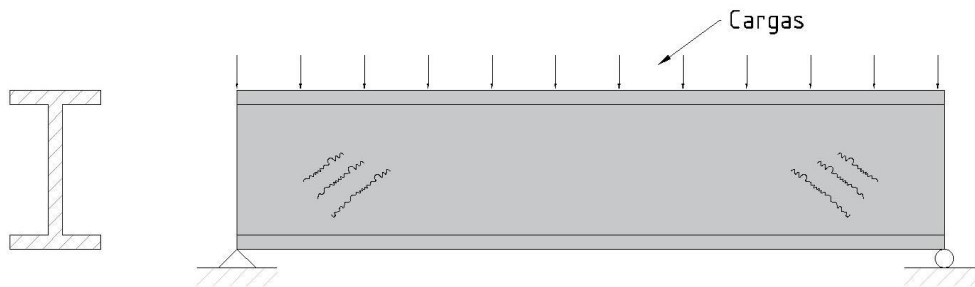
Fisuras por cortante (Carrasco Castro 2010)
